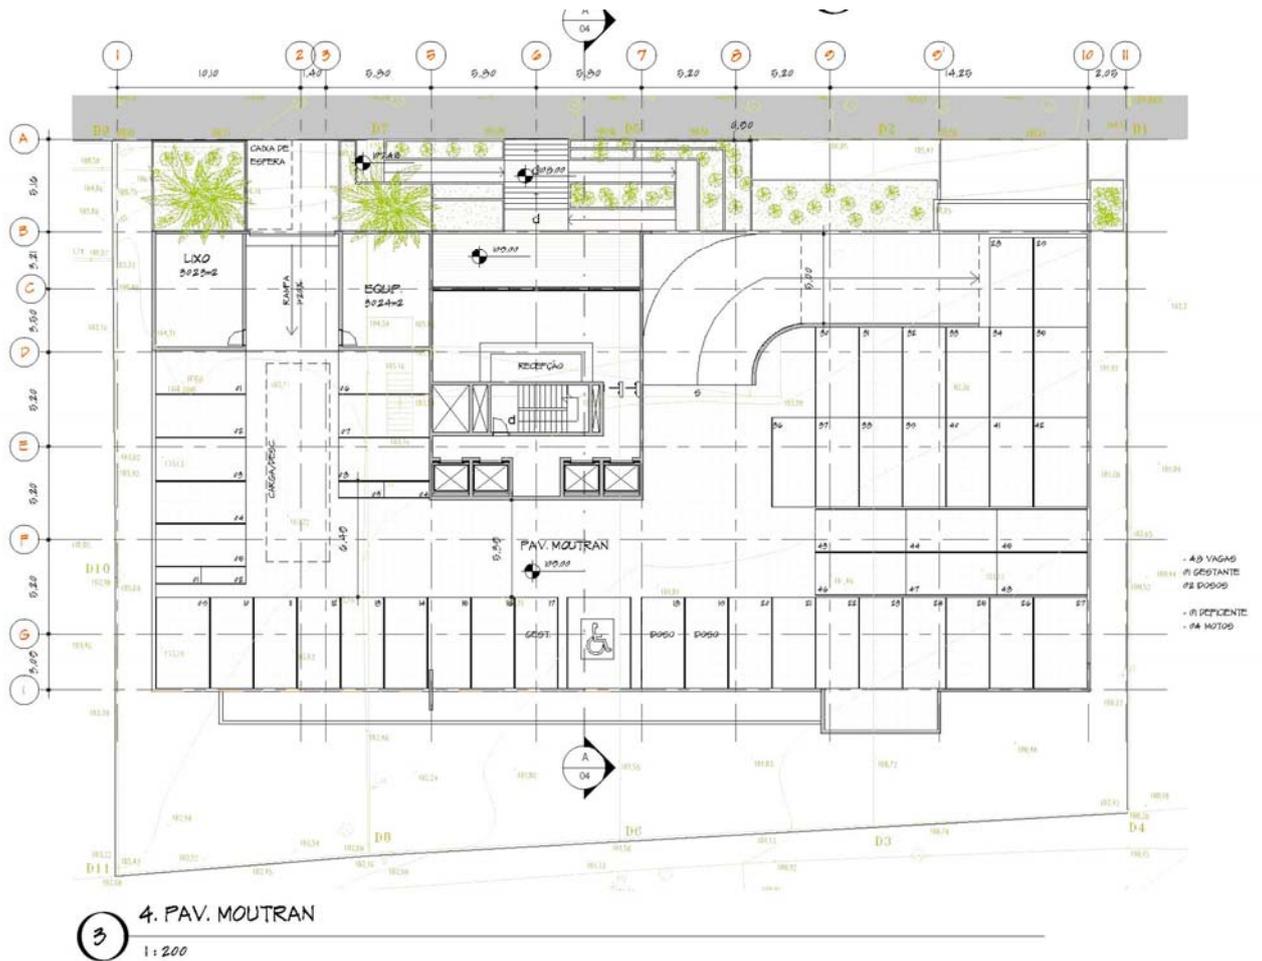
Planta do Pavimento Paulo Mouran – Garagem.
